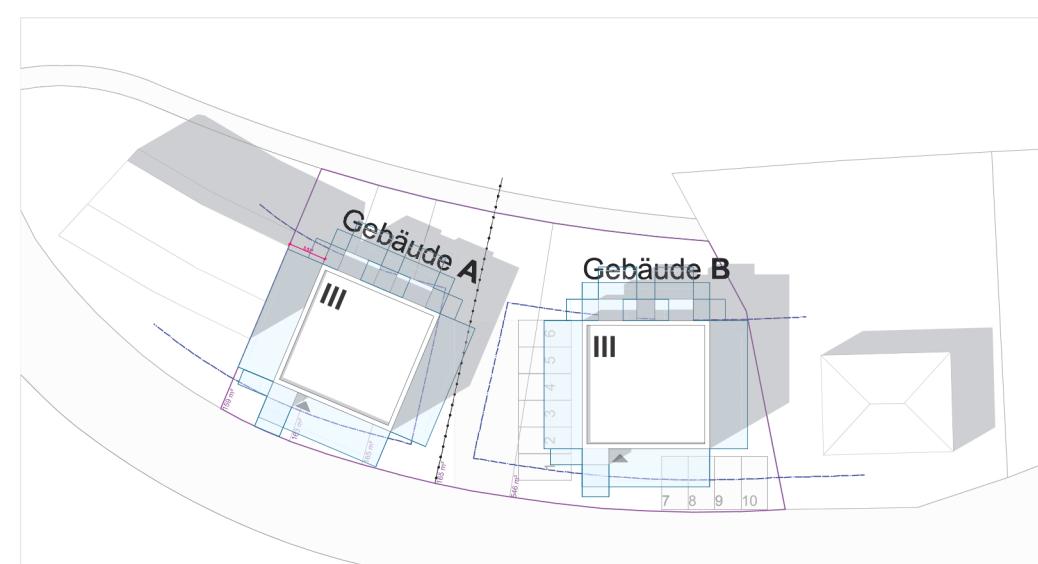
Lage des Bauvorhabens innerhalb des Bebauungsplanes
